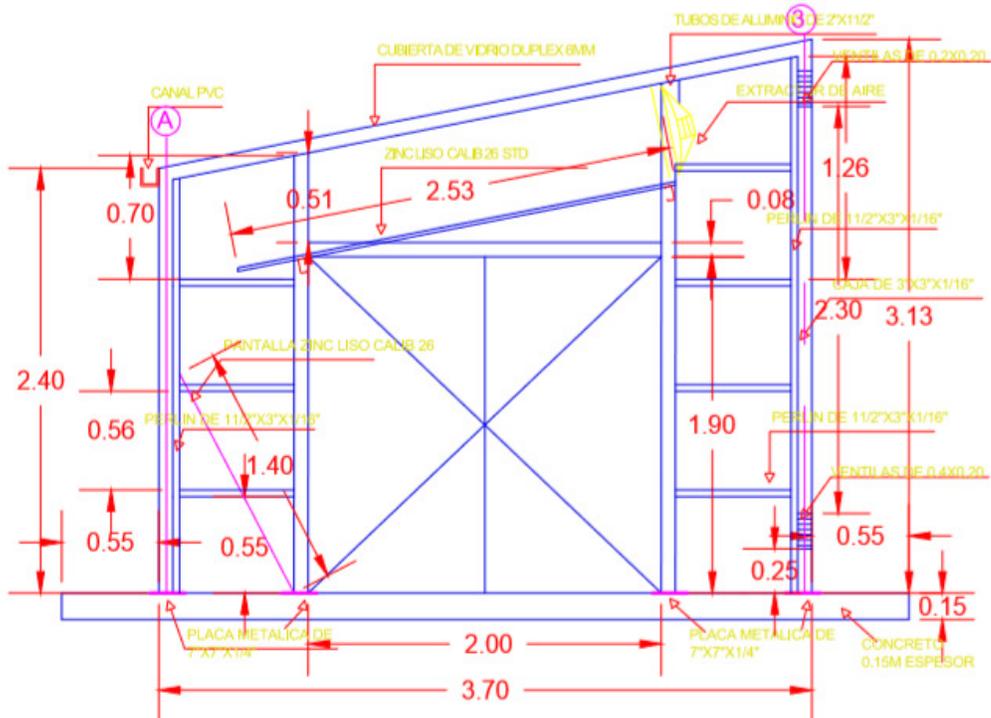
Elevación estructural lado A, Fuente: PIMA.
